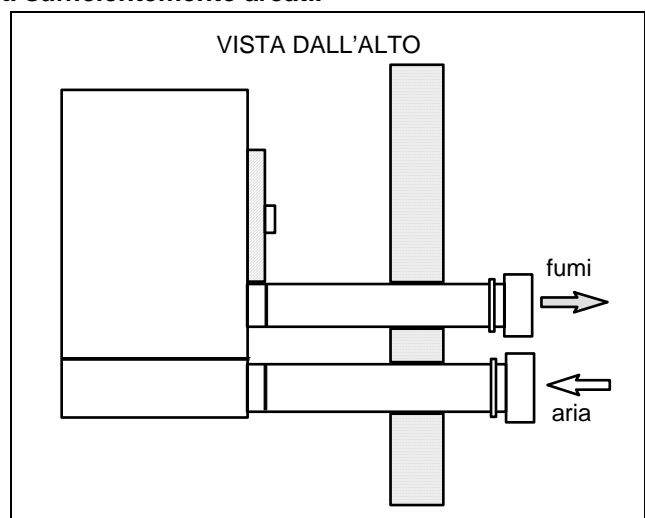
INSTALLAZIONE TIPO C12 CON CONDOTTI SEPARATI A PARETE
